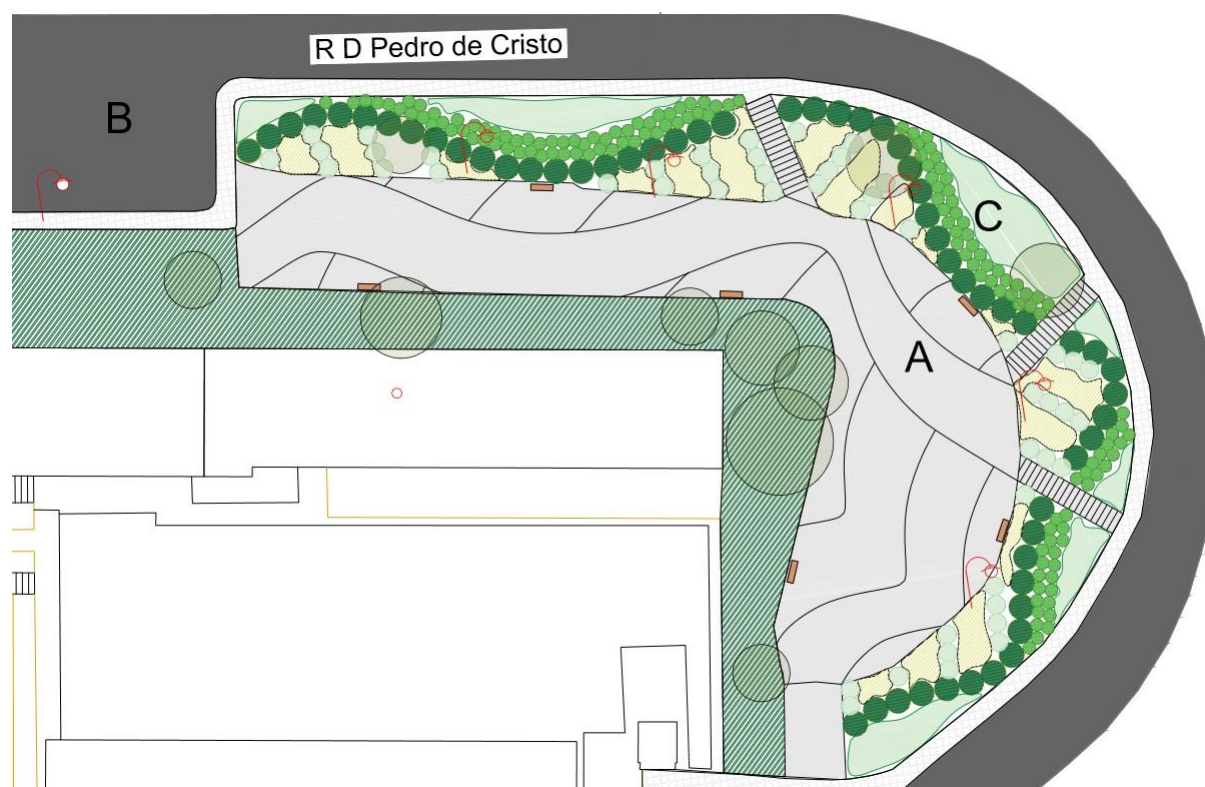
Proposta: Planta Geral Rua Dom Pedro Cristo.
